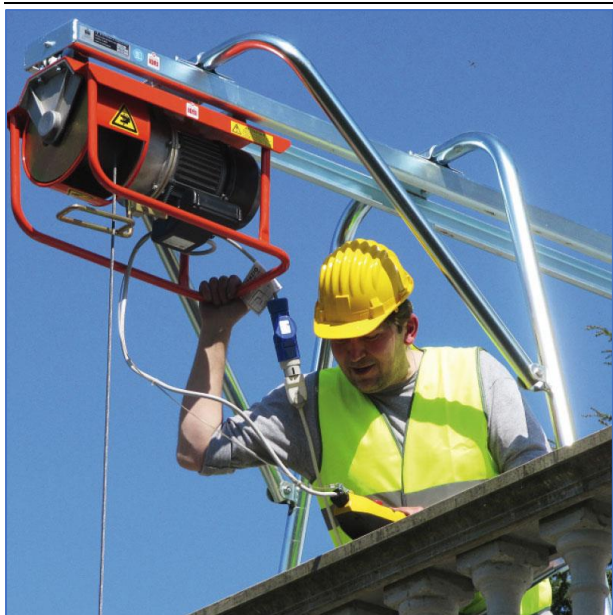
Elevatore su cavalletto per movimentazione verticale.
